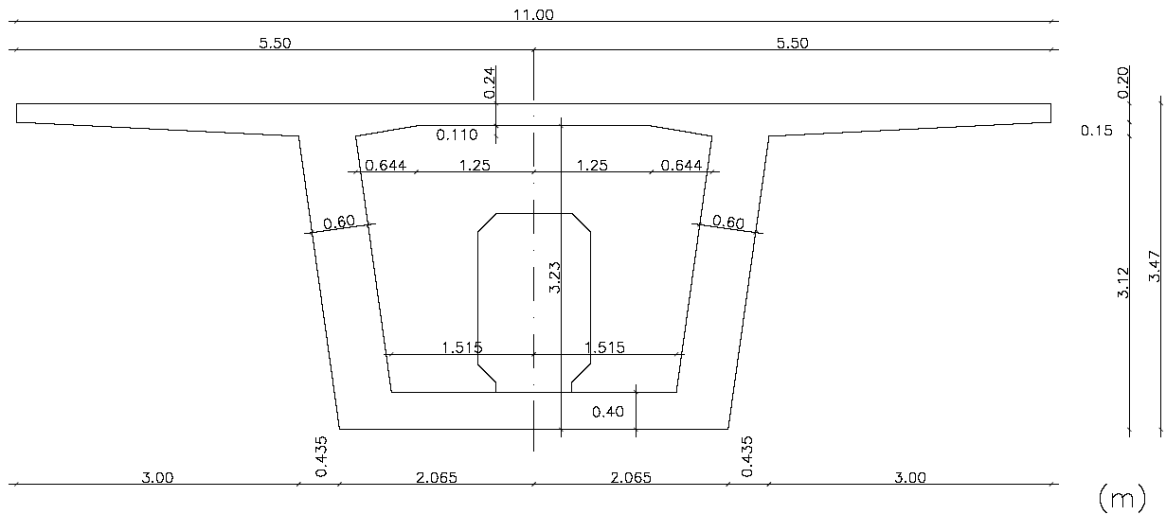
Secção transversal do tabuleiro sobre os pilares
